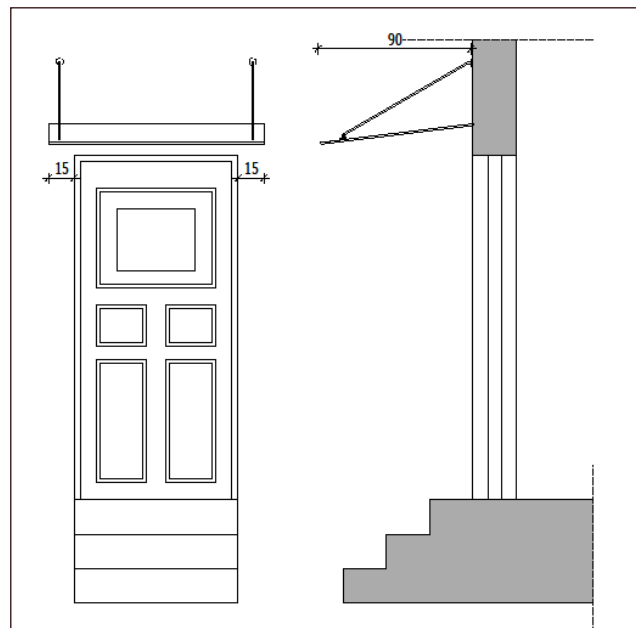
Ansicht und Schnitt Vordach Stahlseil
